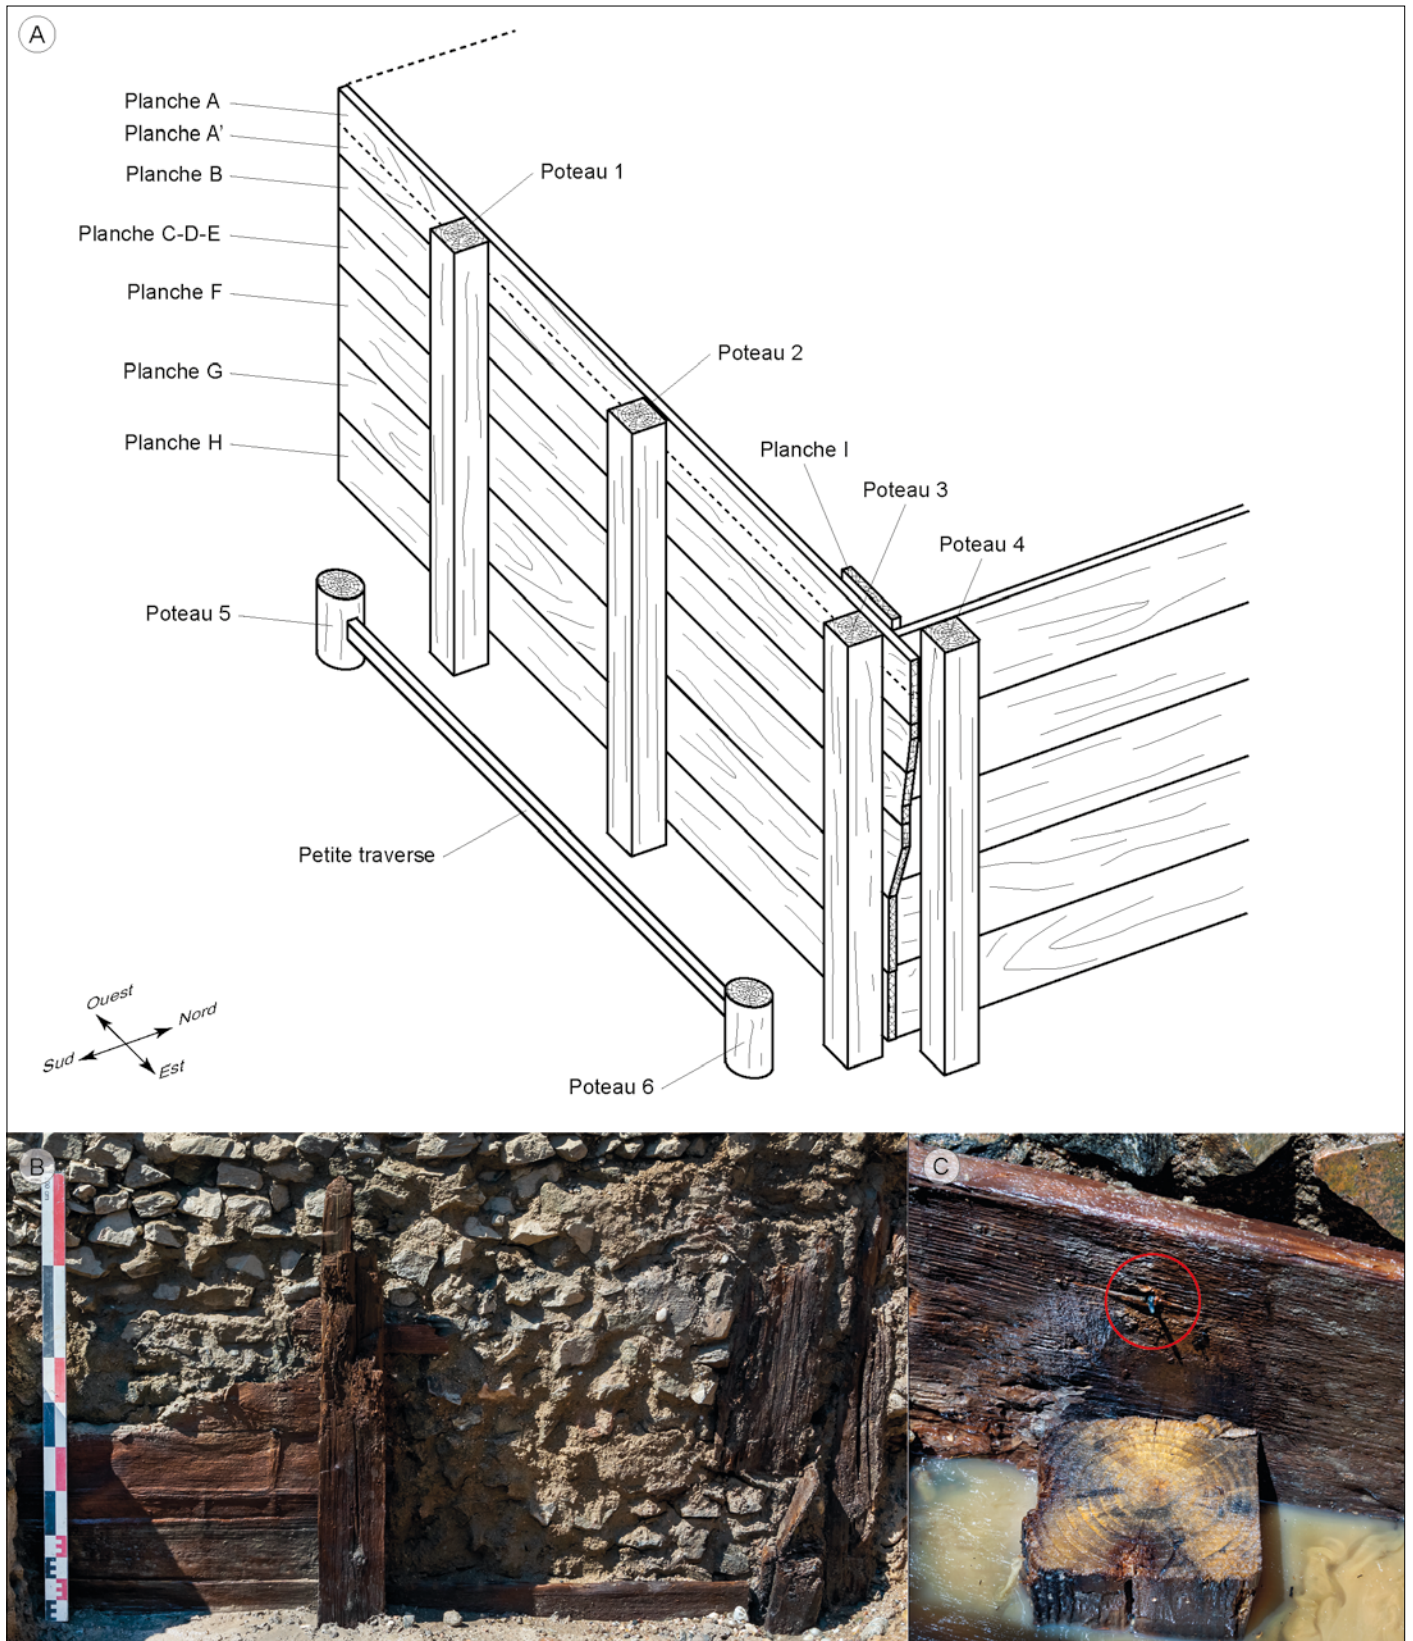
Coffrage de fondation de la pile 18 du pont-siphon de Beaunant à Sainte-Foy-lès-Lyon : A, schéma de principe du coffrage de fondation de la pile 18 avec différenciation des bois conservés et étudiés ; B, vue de la paroi sud du coffrage en cours de dégagement ; C, détail d'un clou dans la planche F fixée au poteau 1. Trois éléments C, D et E ont été identifiés séparément sur le terrain, avant d'être identifiés comme appartenant finalement à une seule et même planche nommée C-D-E (DAO: F. Blondel, C-CIA, UNIGE; clichés: D. Baldassari).
